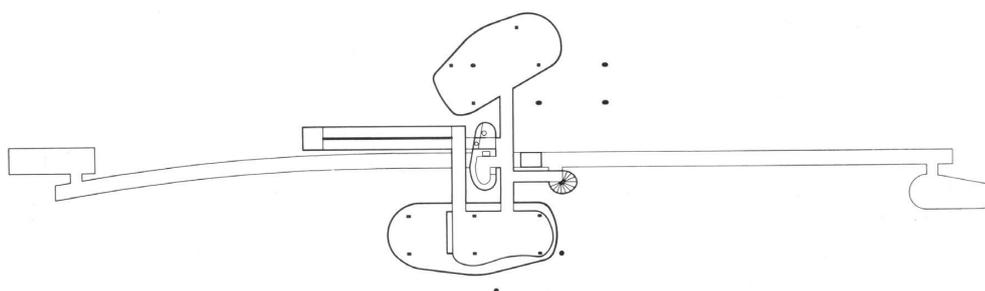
John Frederick Colamarino, *House* (1968-1969). Planta baixa pav. inferior.
